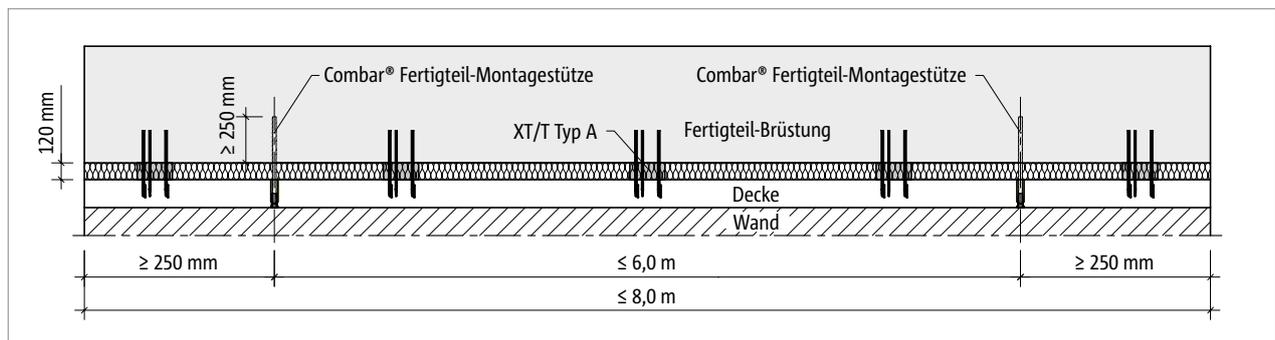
Schöck Isokorb® XT/T Typ A mit Combar® Fertigteil-Montagestütze: Randabstände und Mindesteinbindelänge in der Fertigteilbrüstung
